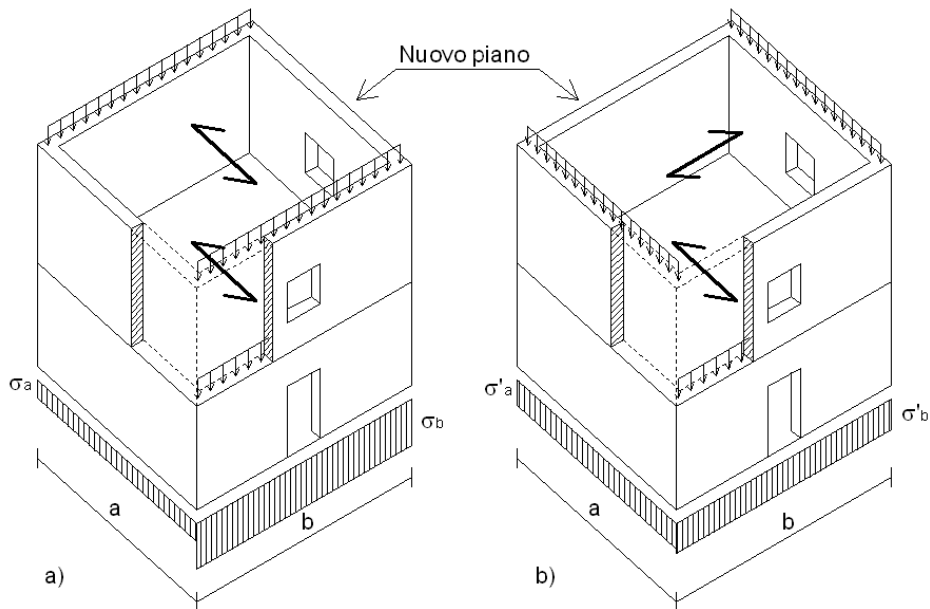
Riduzione delle tensioni in fondazione attraverso l'orditura dei solai
